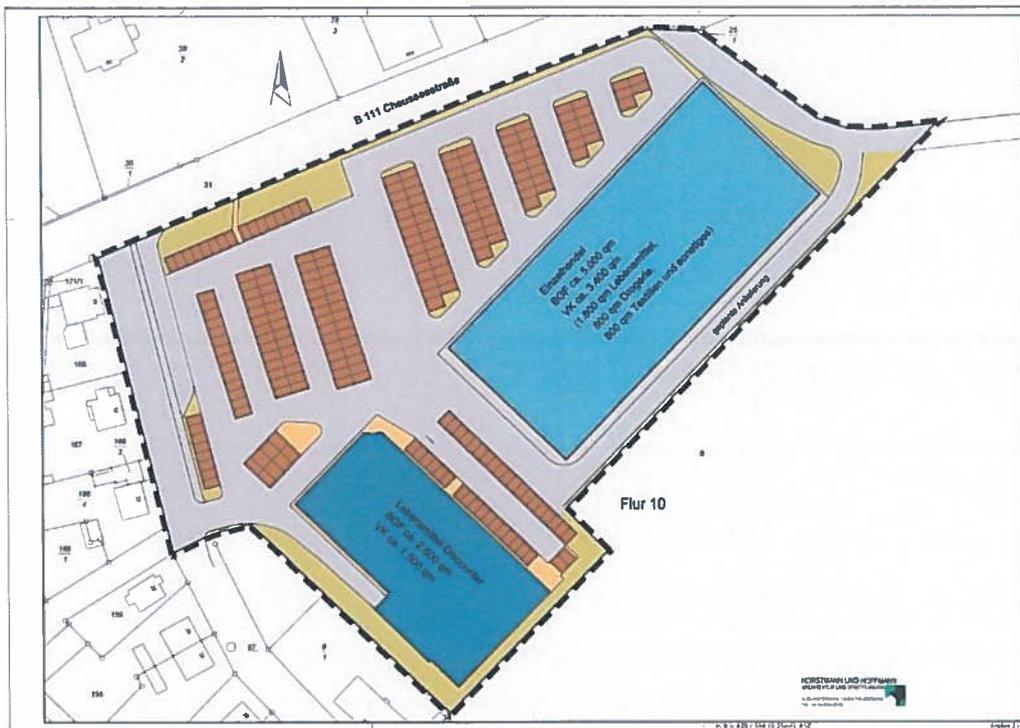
Auszug B-Plan 30 Planzeichnung.
